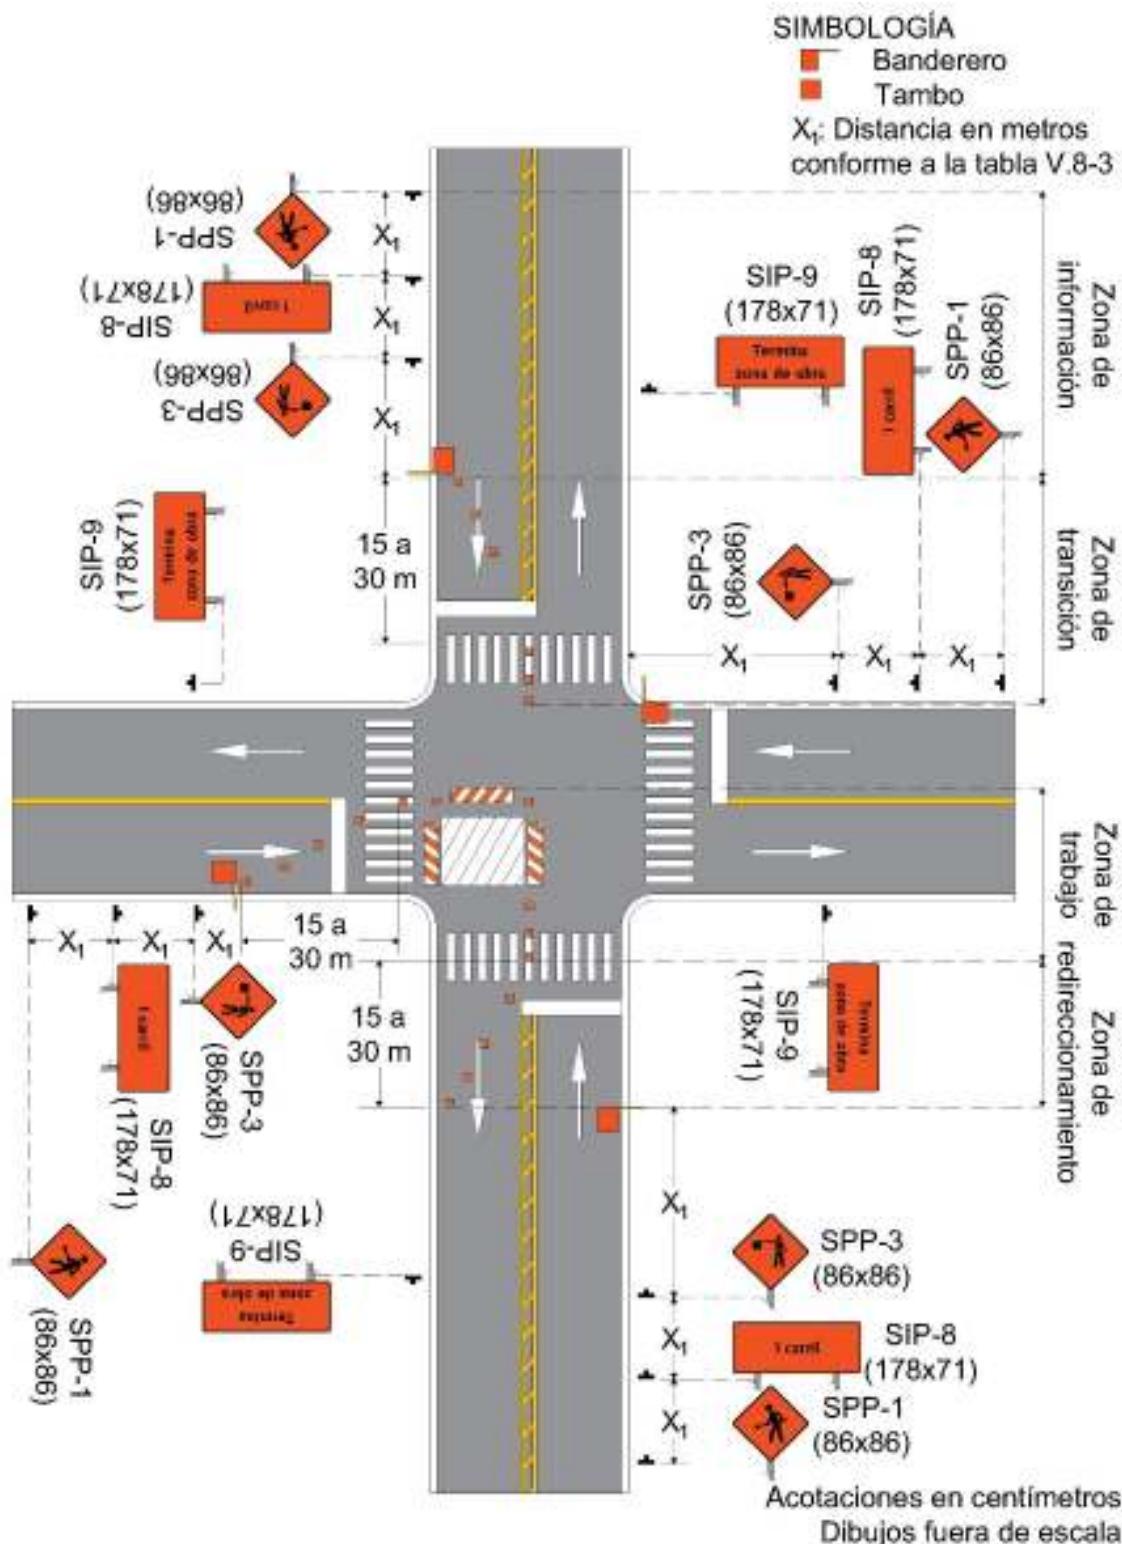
Cierre de carriles en el costado de una intersección (Vía con ancho de arroyo vial menor a 9 m)
